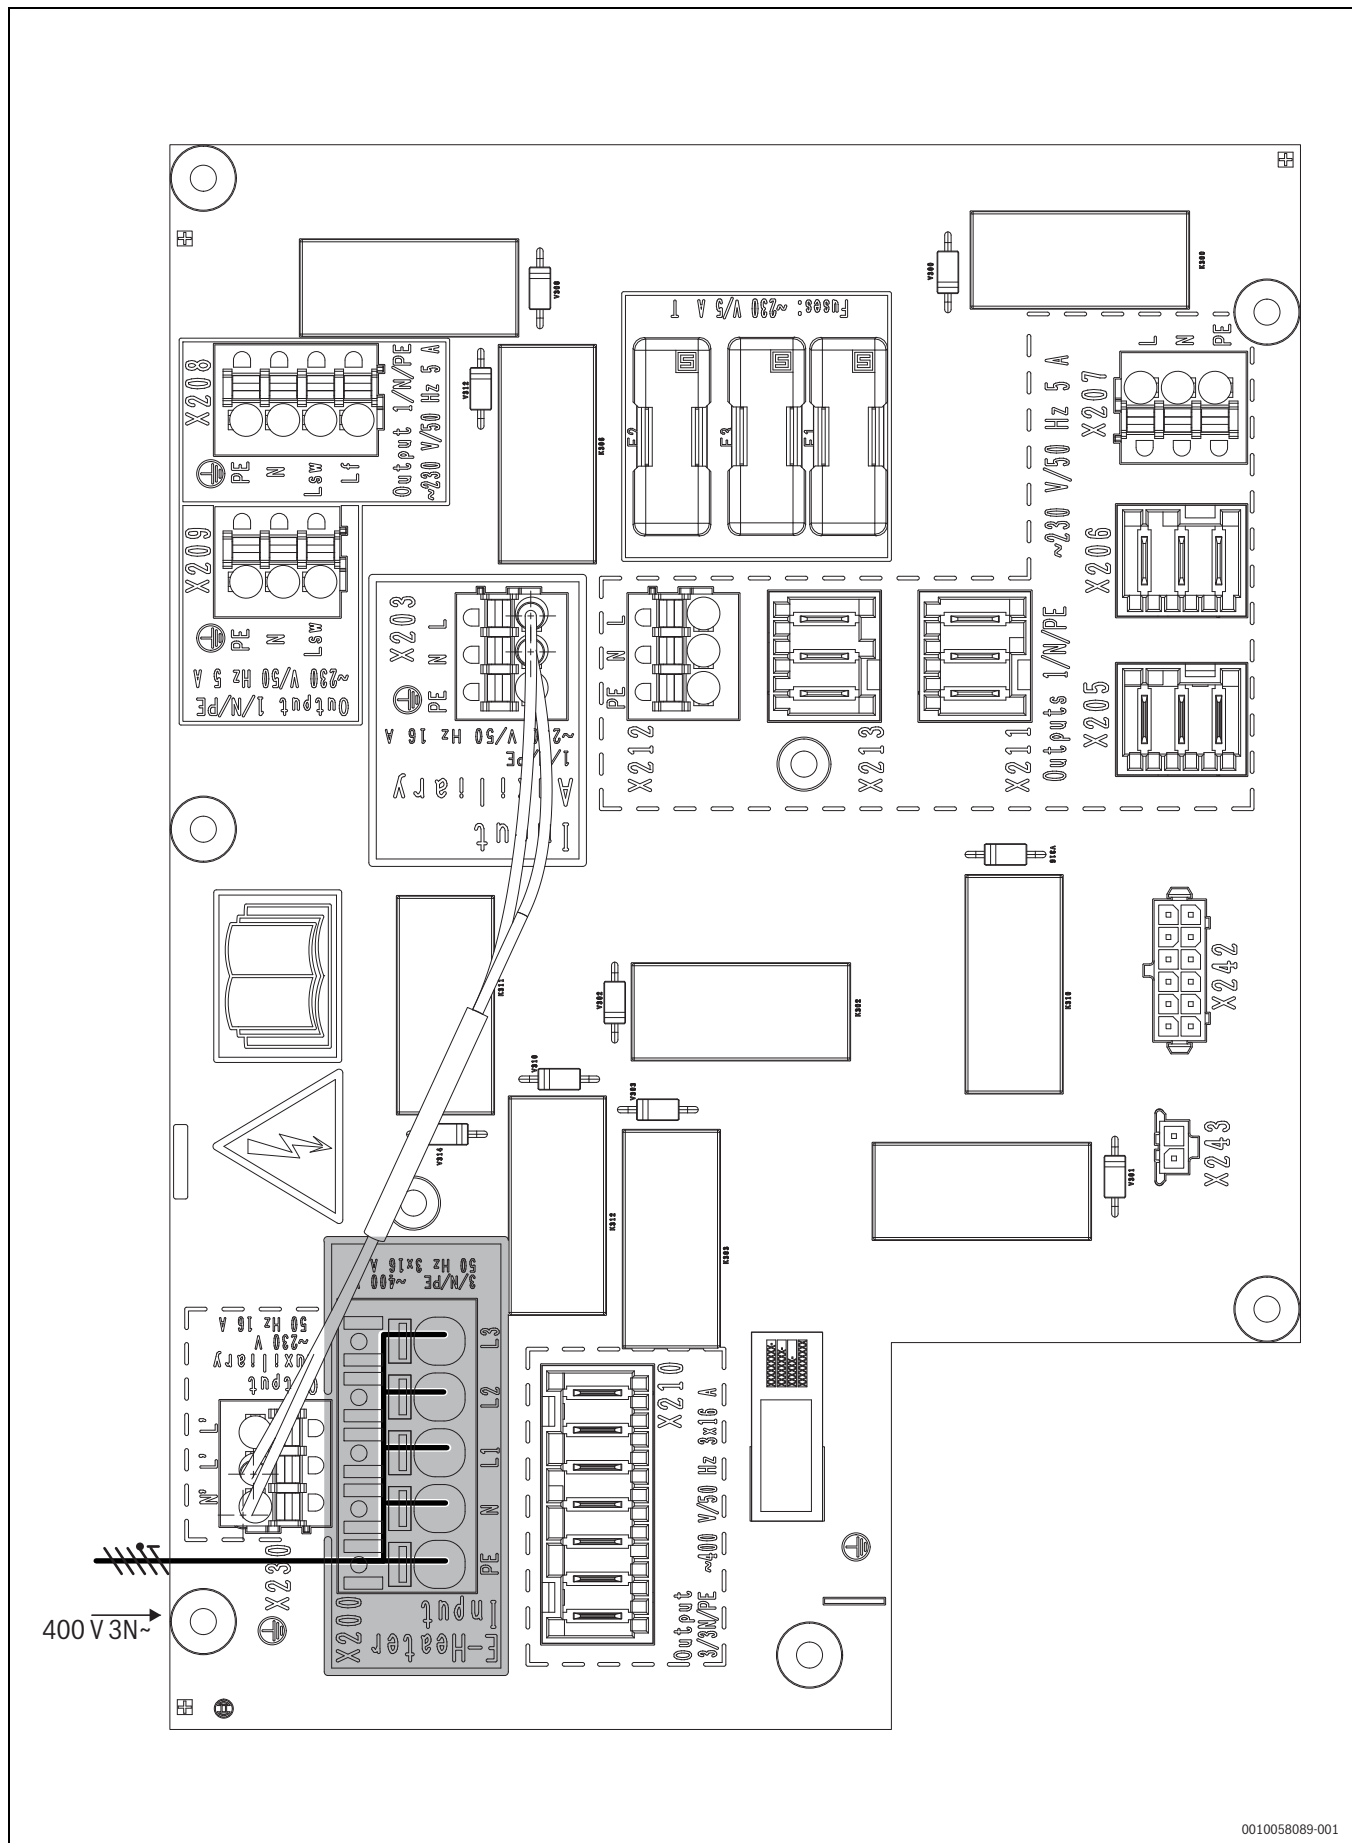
400 V-Anschluss für den elektrischen Zuheizler mit gebrücktem 230 V-Anschluss für Steuerung und Pumpen
